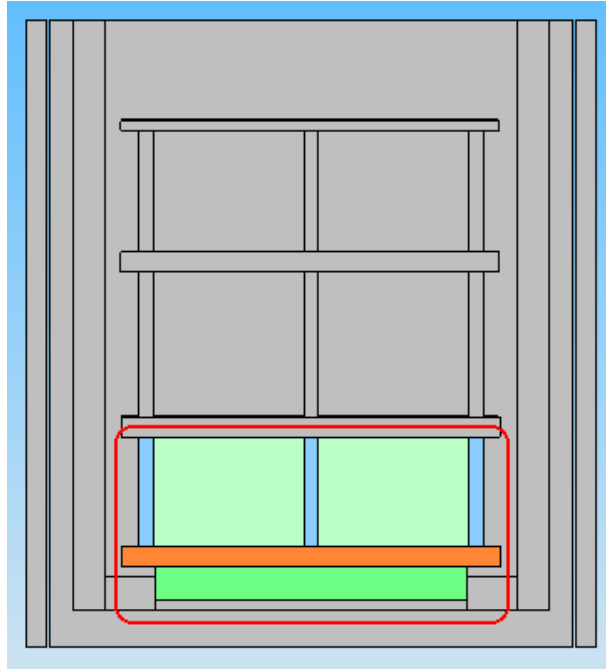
6: Detalle de la base y la planta 1 en el interior del cubo
